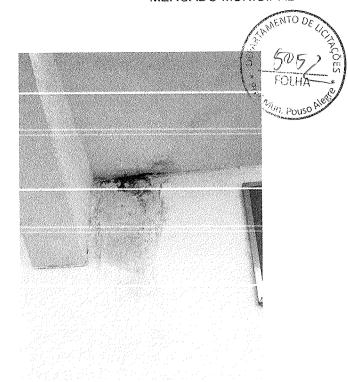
Mofo na parede e laje do lado esquerdo da edificação
